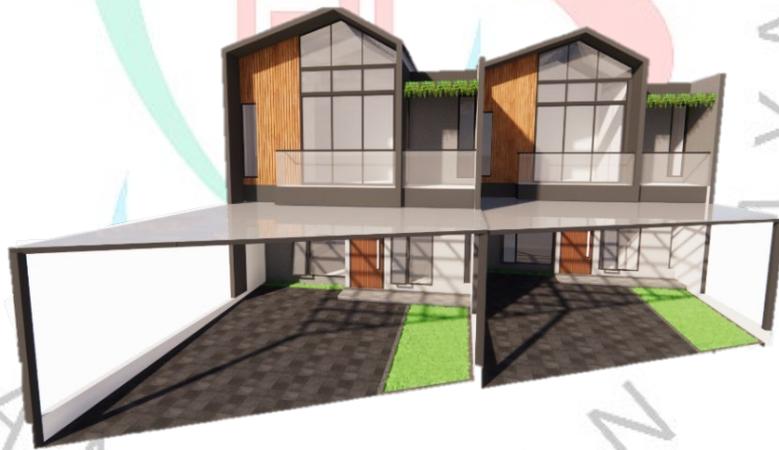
1 Masterplan awal Navia Tipe 6
